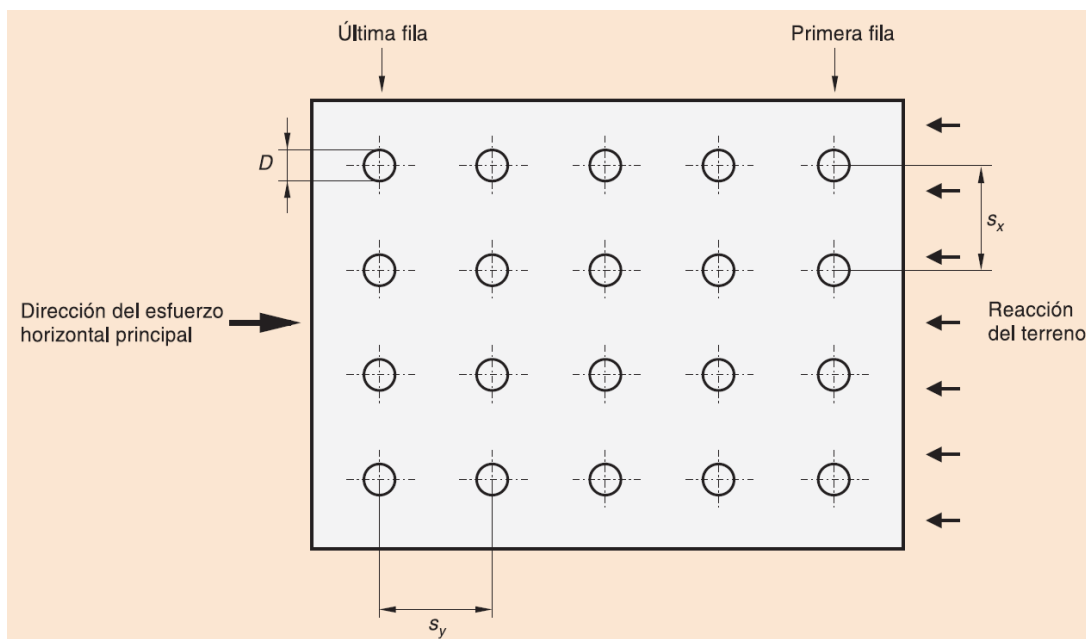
Esquema de los parámetros que definen el coeficiente de mayoración de la longitud elástica de los pilotes del grupo (Guía de Cimentaciones de Obras de Carretera).
